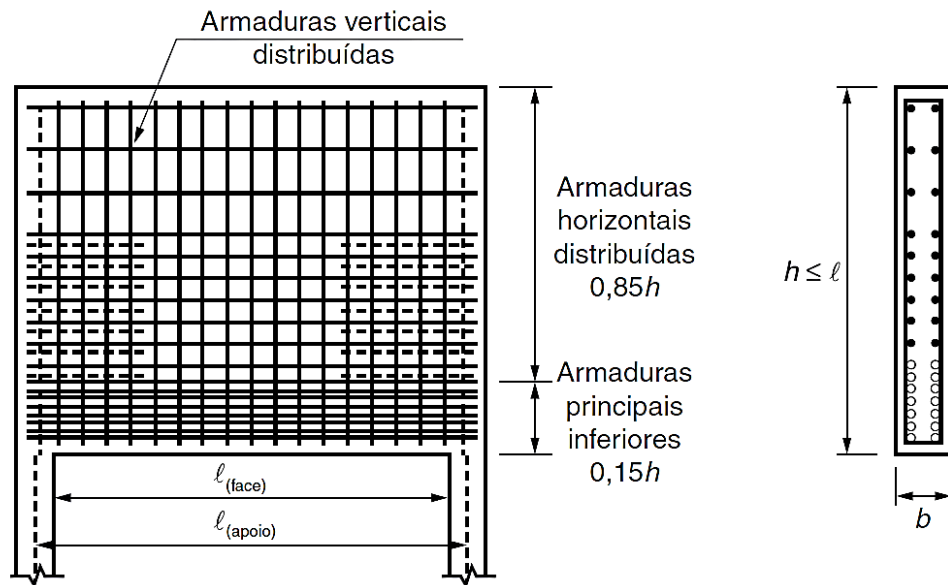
Esquema de distribuição de armaduras para uma viga alta segundo a NBR 6118:2014 (NBR 6118:2014)
